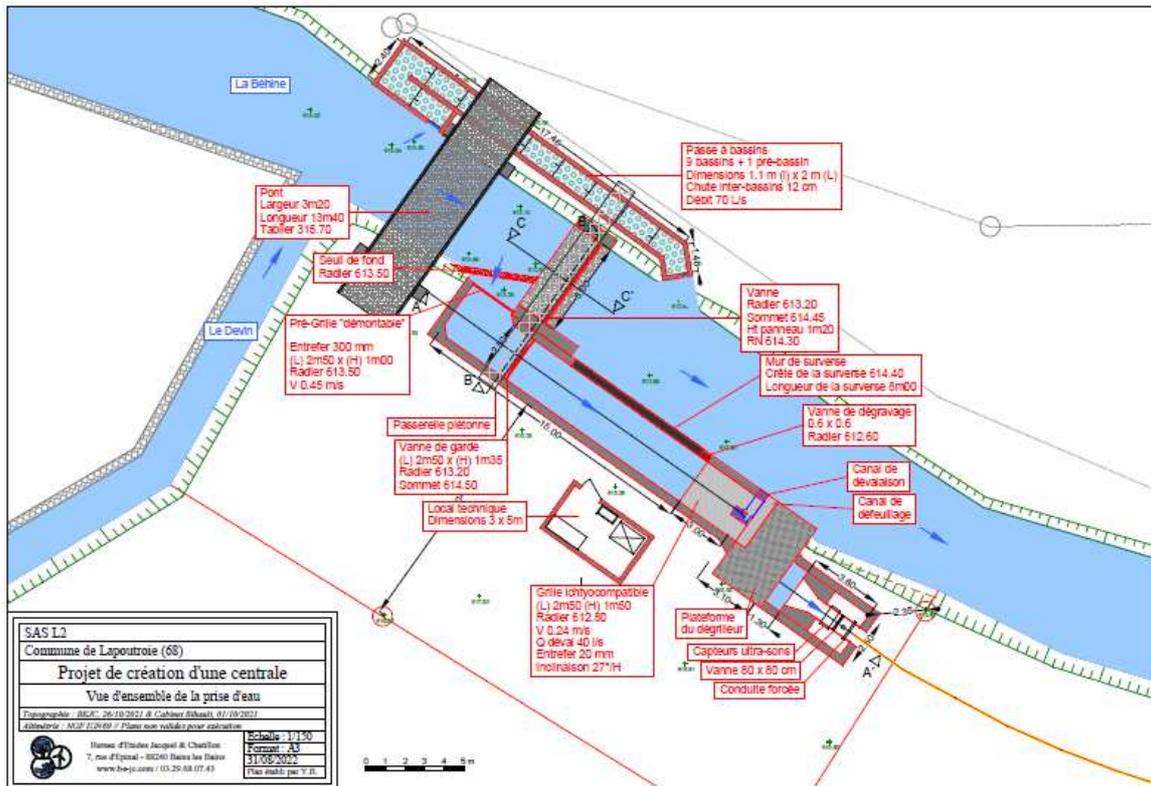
Plan projet – Prise d'eau (Source : BEJC)
